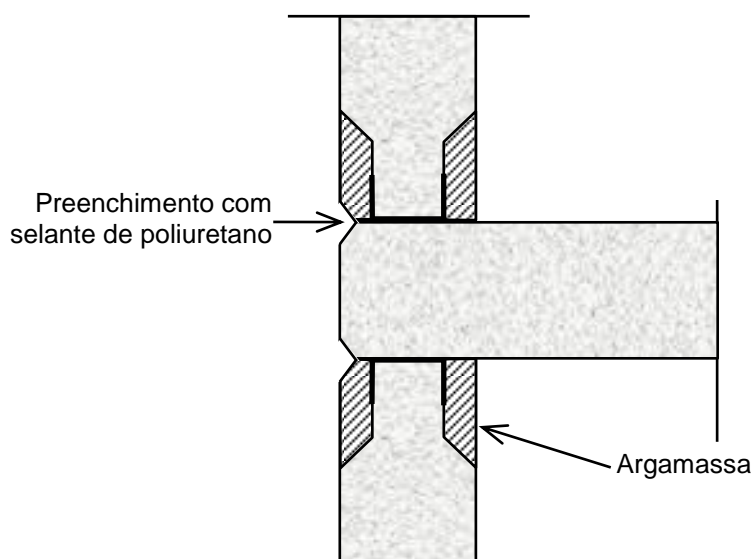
Esquema do tratamento das juntas horizontais entre painéis e laje (sem escala)
